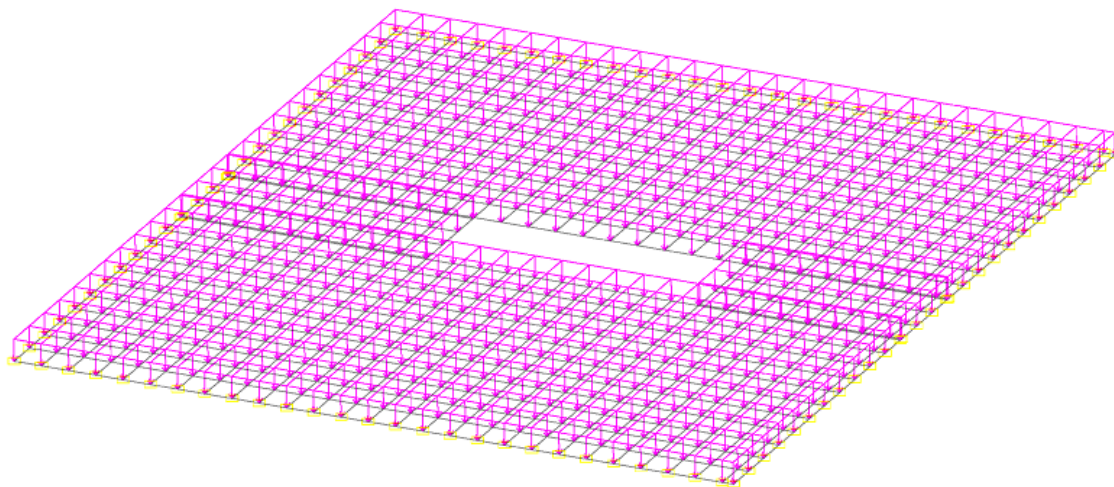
Расчетная схема плиты перекрытия
